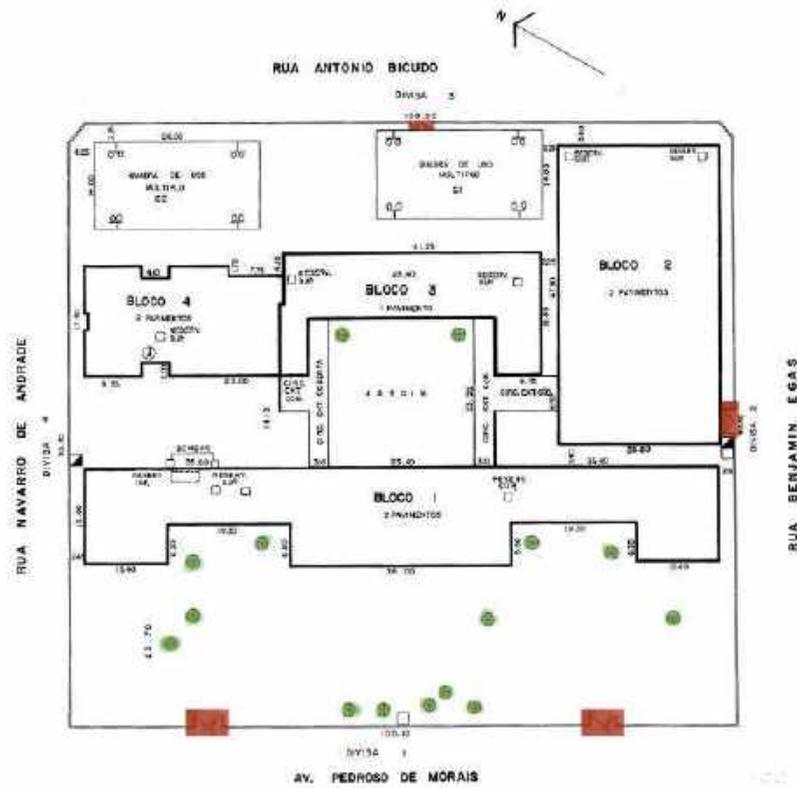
Planta baixa das edificações da escola, 1992 Fonte: FDE. Adaptada pela autora, 2021.
